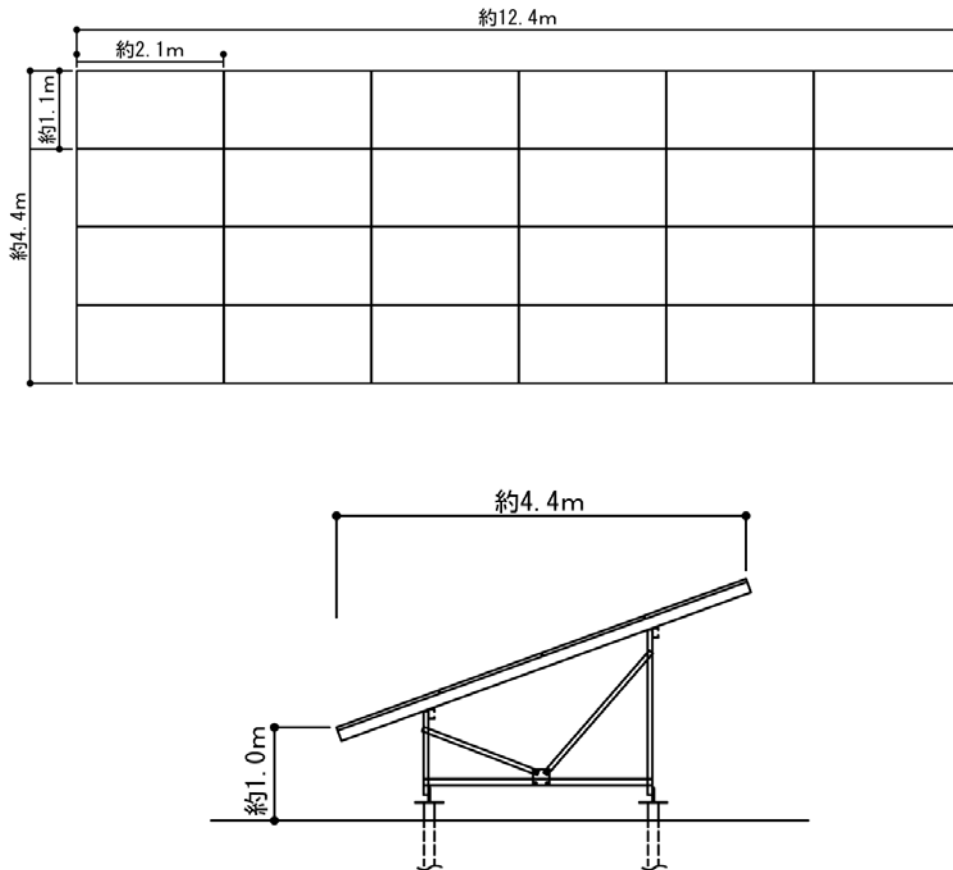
太陽光パネル（アレイ）平面図及び架台断面図（例）
